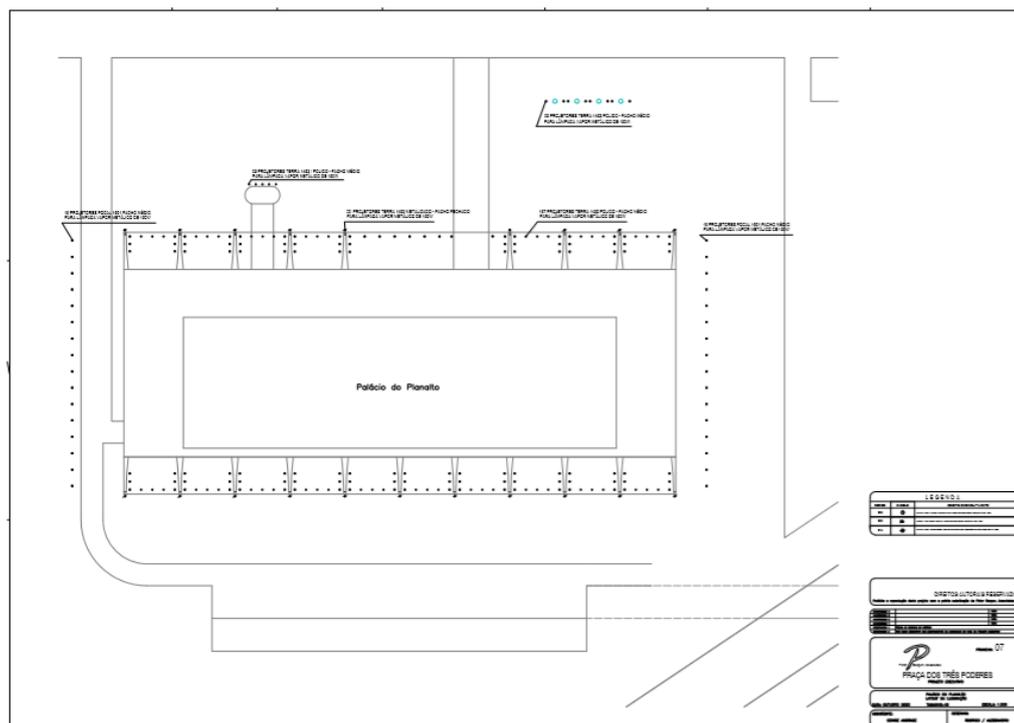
Planta luminotécnica do prédio do Palácio do Planalto¹¹⁸
